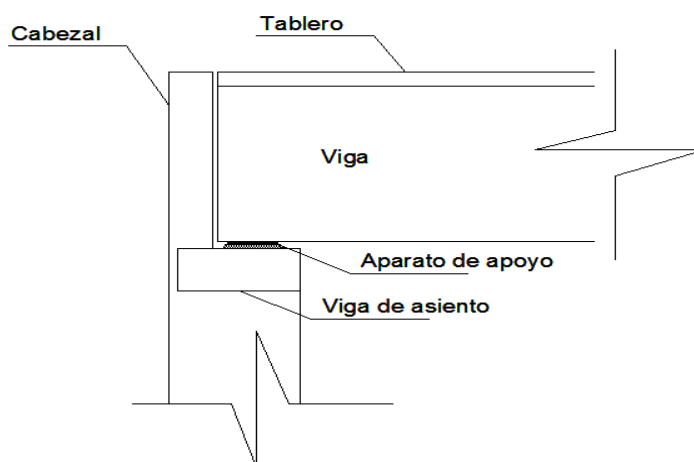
Ubicación de la viga de asentamiento. Elaborado por: Autor
